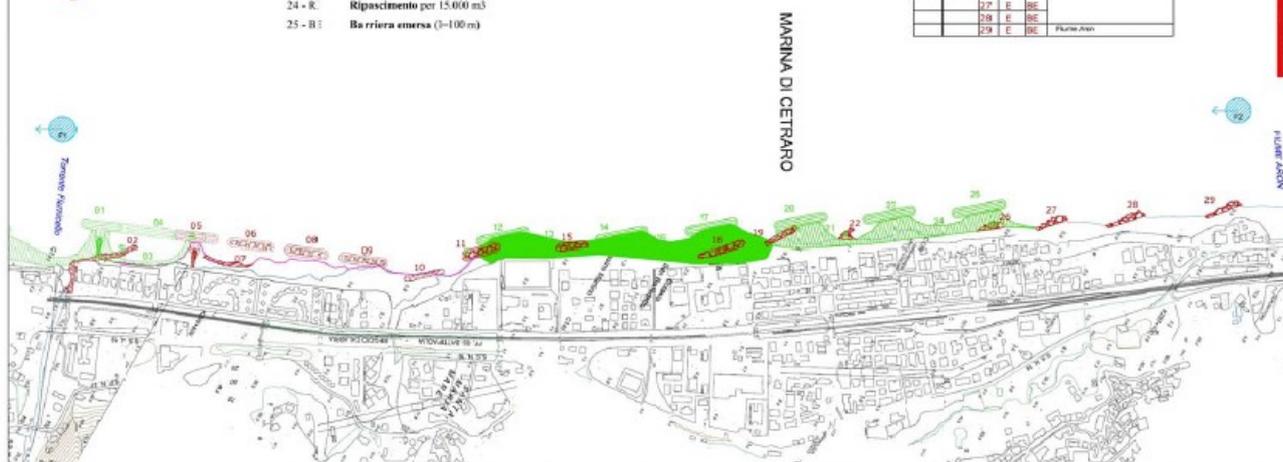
Stralcio del Master Plan relativo alla zona di intervento
